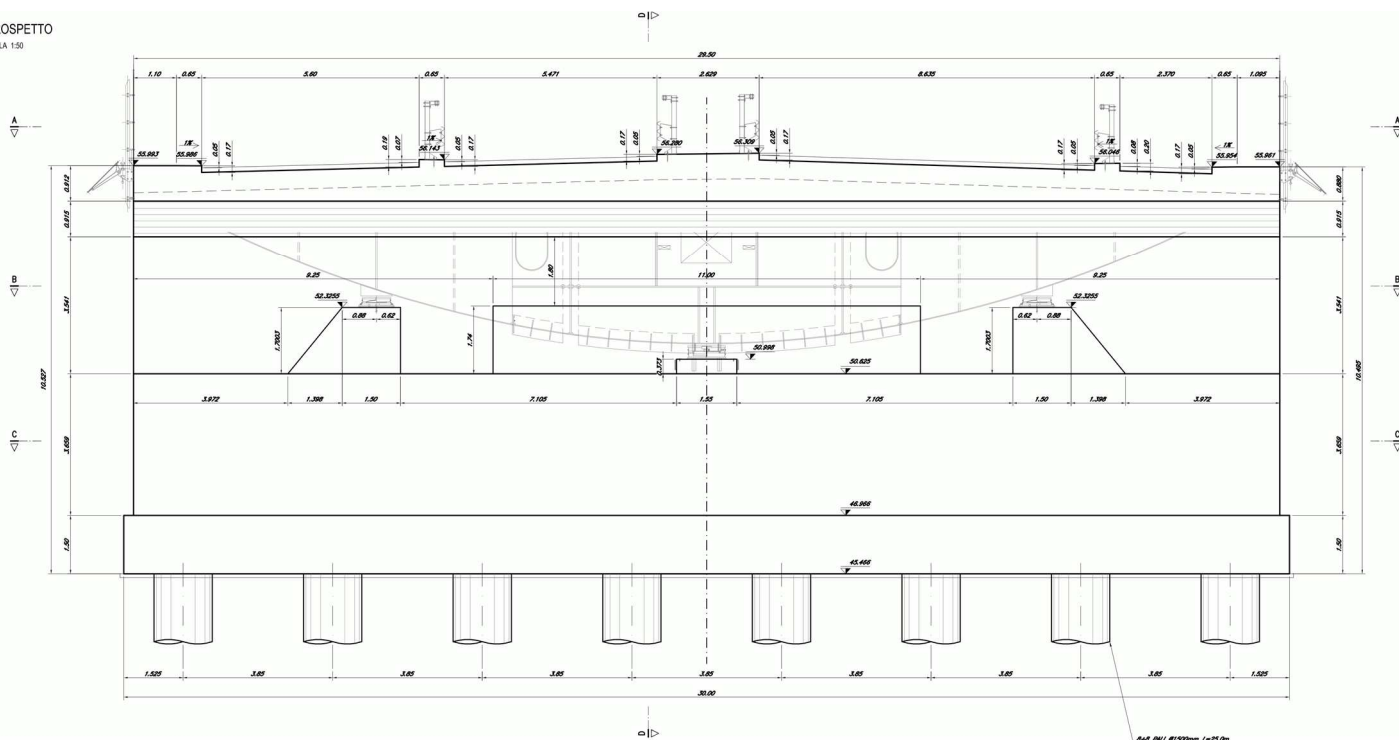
Geometria della spalla – vista longitudinale
